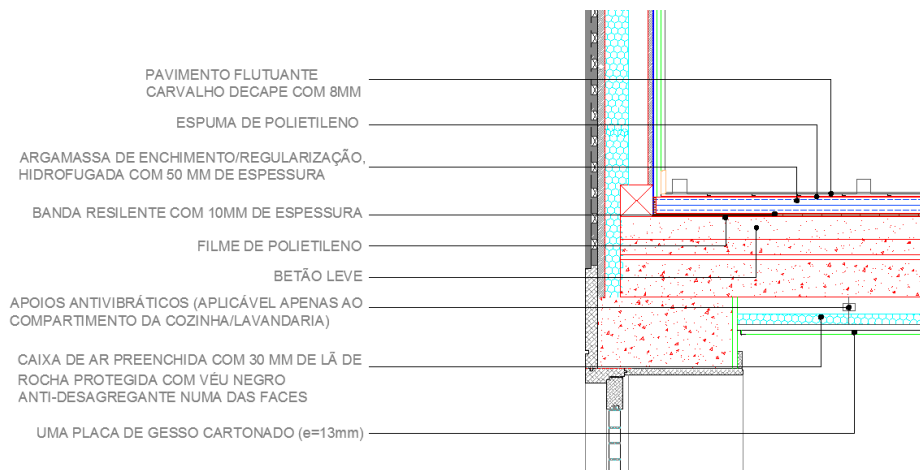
Pormenor de laje do compartimento de cozinha/lavandaria
